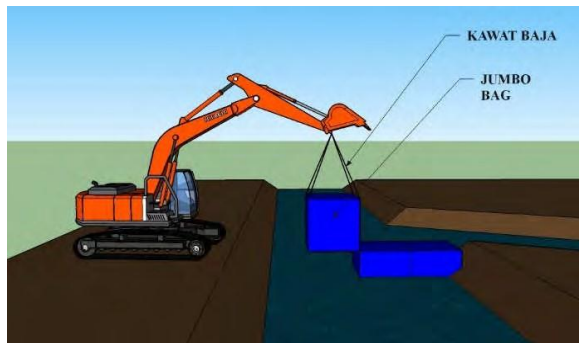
12 Jumbo bag dan steel sheet pile telah terpasang di bendung pengelak hulu
